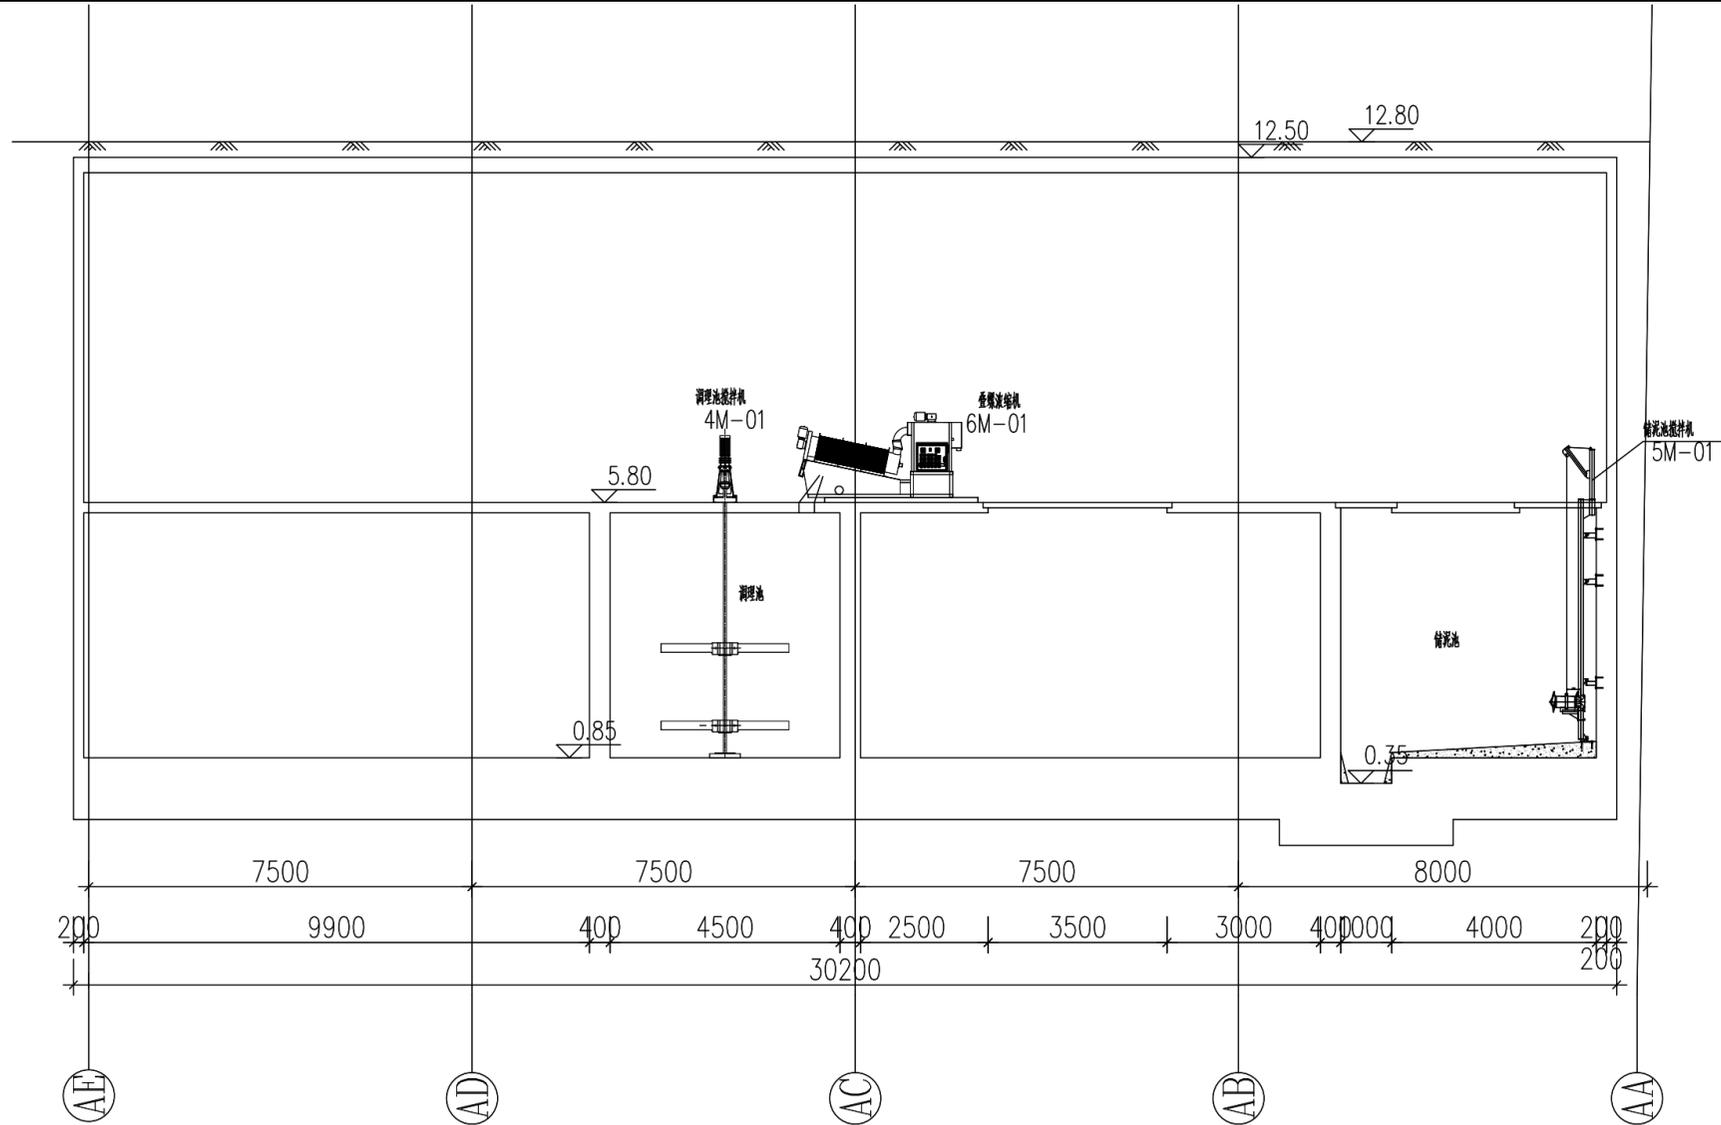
污泥脱水车间剖面图 (C-C 断面)
